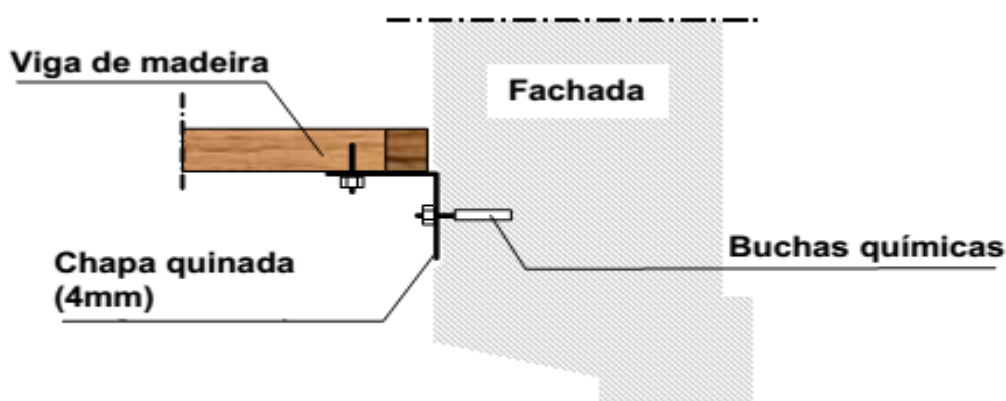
Travamento de fachada (Fonte: Faculdade)
